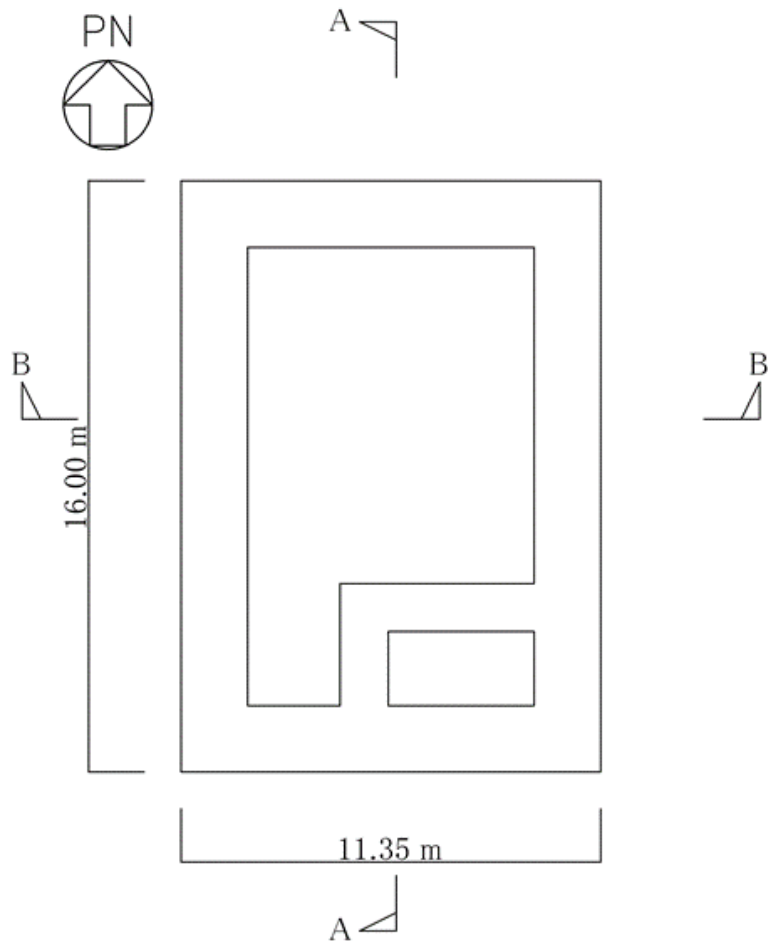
格納容器圧力逃がし装置格納槽の概略平面図 (EL. -12.8 m)
